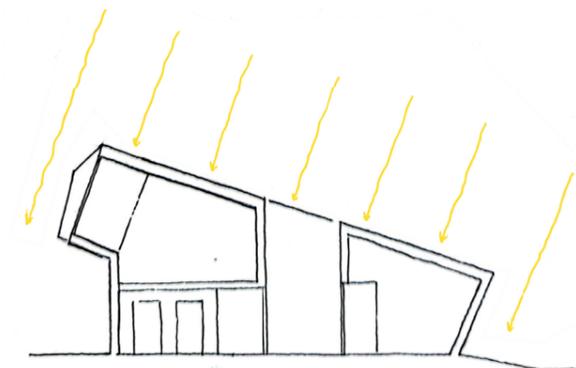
| Plano de situación ZEB Pilot House | Snøhetta.
